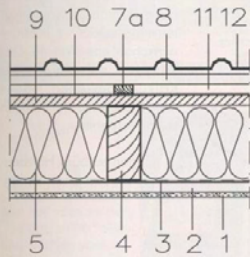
Geneigtes Dach mit Vordeckung auf Sparschalung
